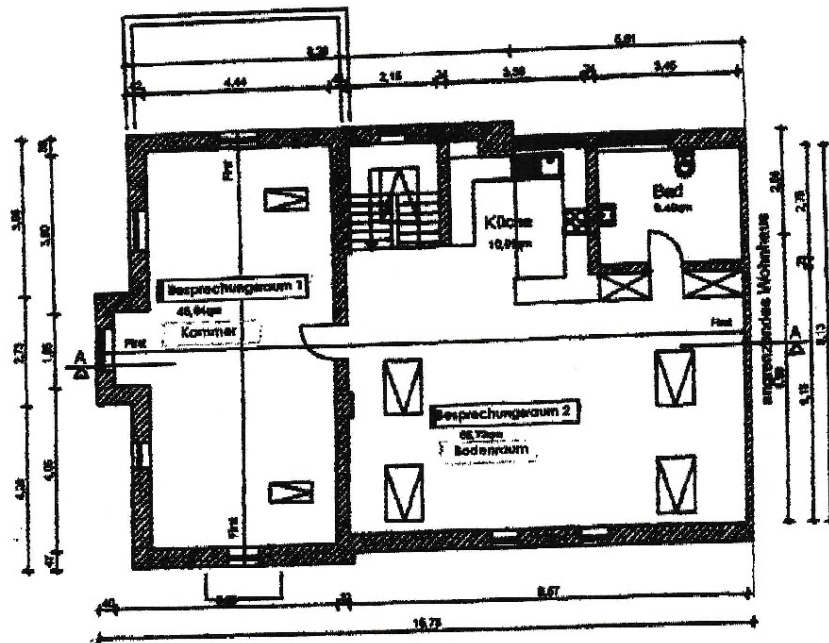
Grundriss 2. Obergeschoss, Hostatostrasse 26, 65929 Frankfurt am Main
